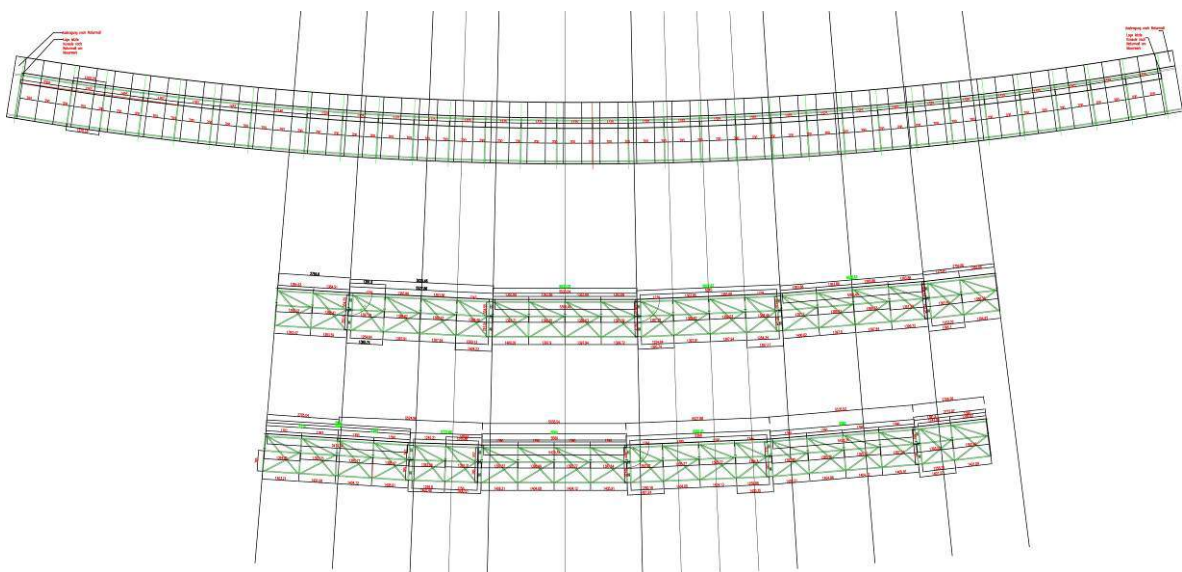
Grundriss: PV auf 3 Ebenen auf konischer Fassade
